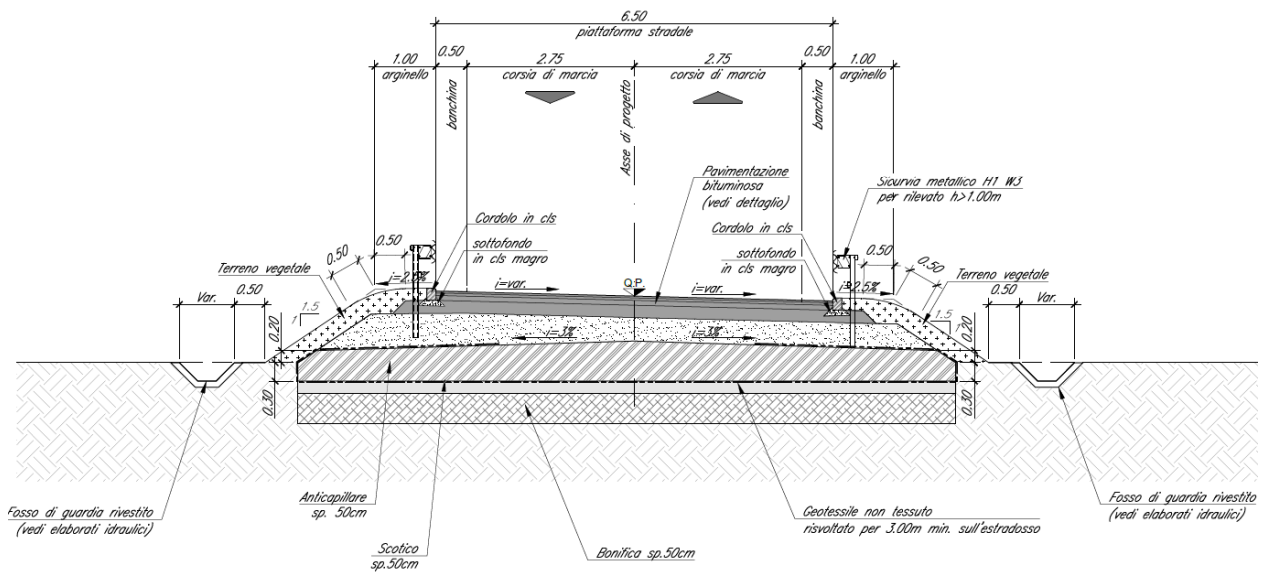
Sezione tipo in rilevato NV16 Asse 3-3A
